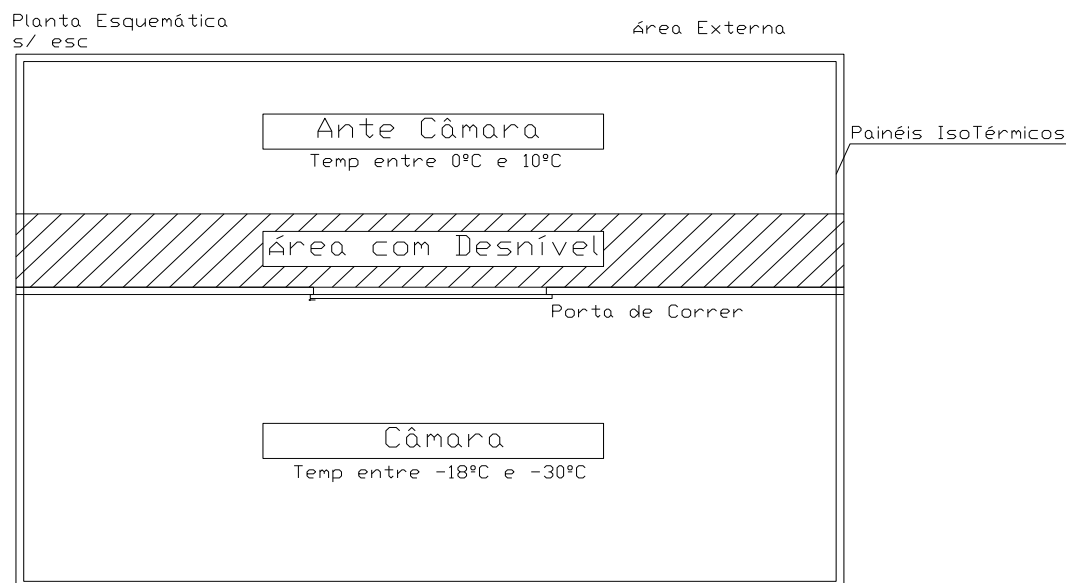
PLANTA ESQUEMÁTICA CÂMARA FRIGORÍFICA
